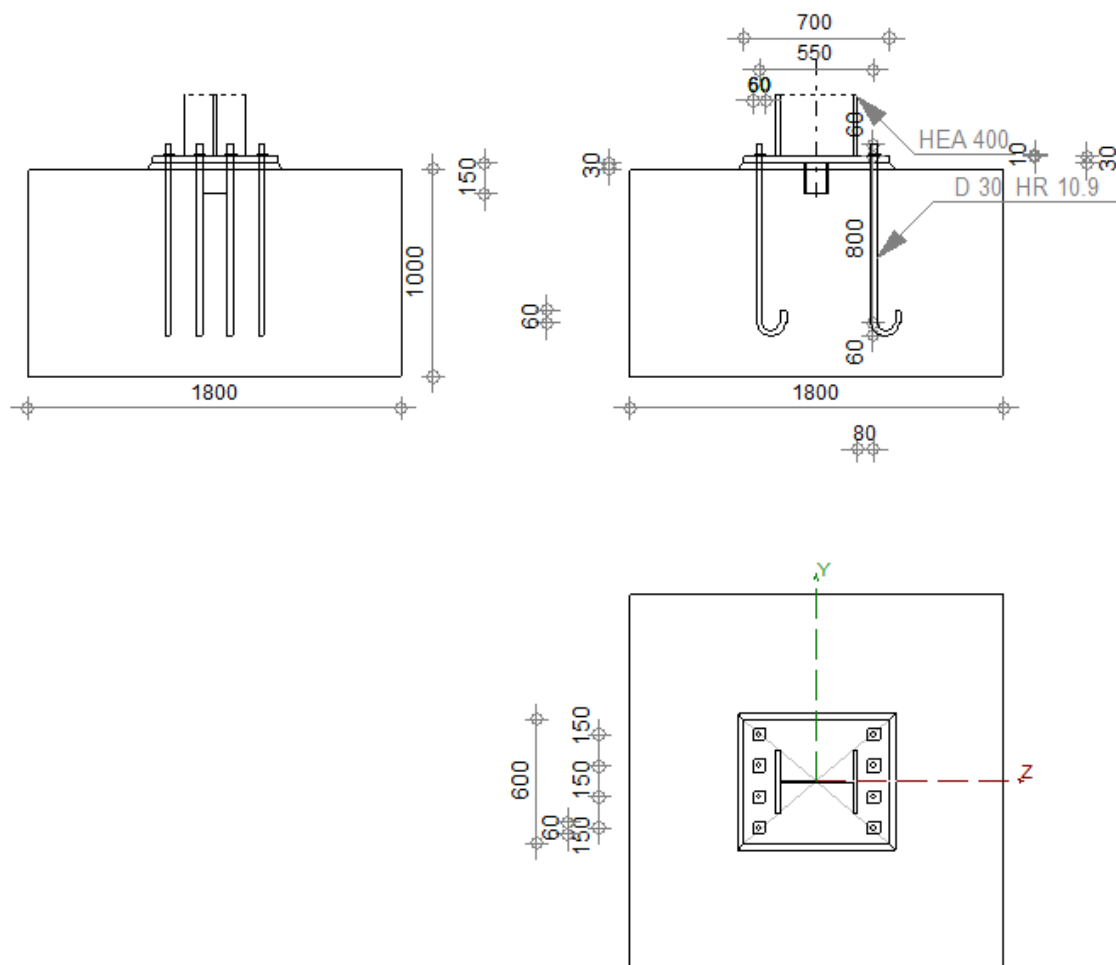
vue en plan de l'assemblage pied de poteau.
